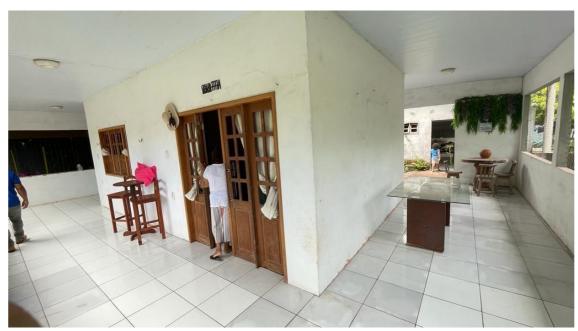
Corredor de circulação: forro em lambril de pvc, paredes argamassadas e com pintura, piso em lajota cerâmica, grades em trama metálica, portão de ferro.
